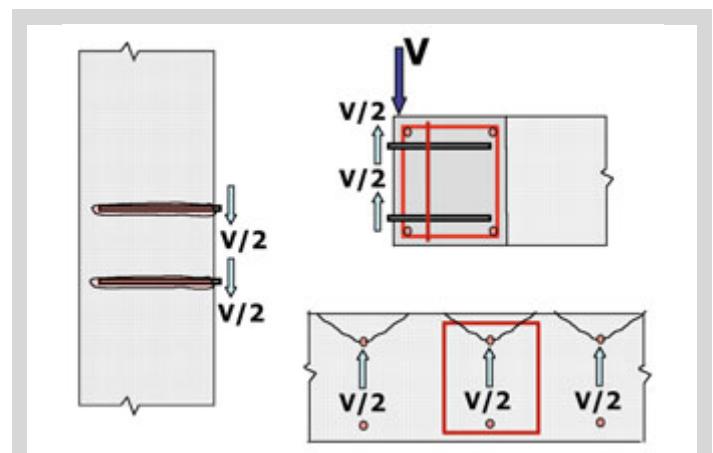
Comprobación de Rotura por borde de hormigón en viga perimetral.
